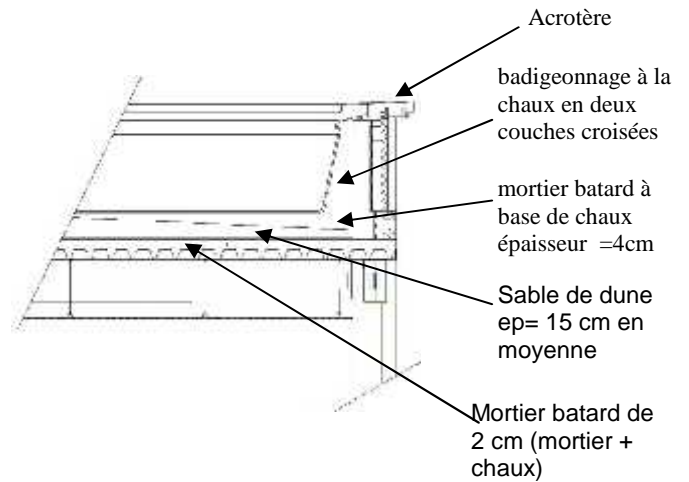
Détail n°09: Détail toiture terrasse (1/50)
